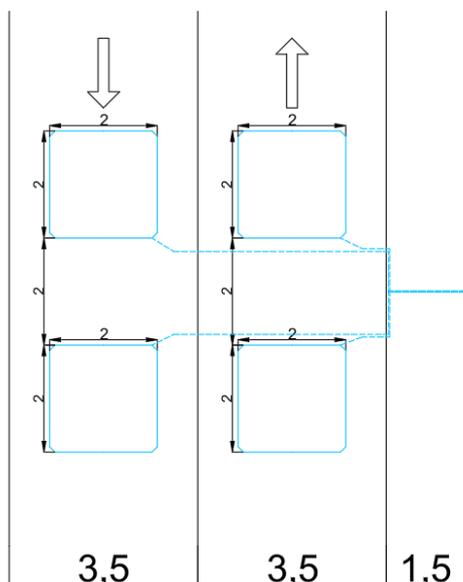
Regatas en calzada. Fuente: Elaboración propia.
